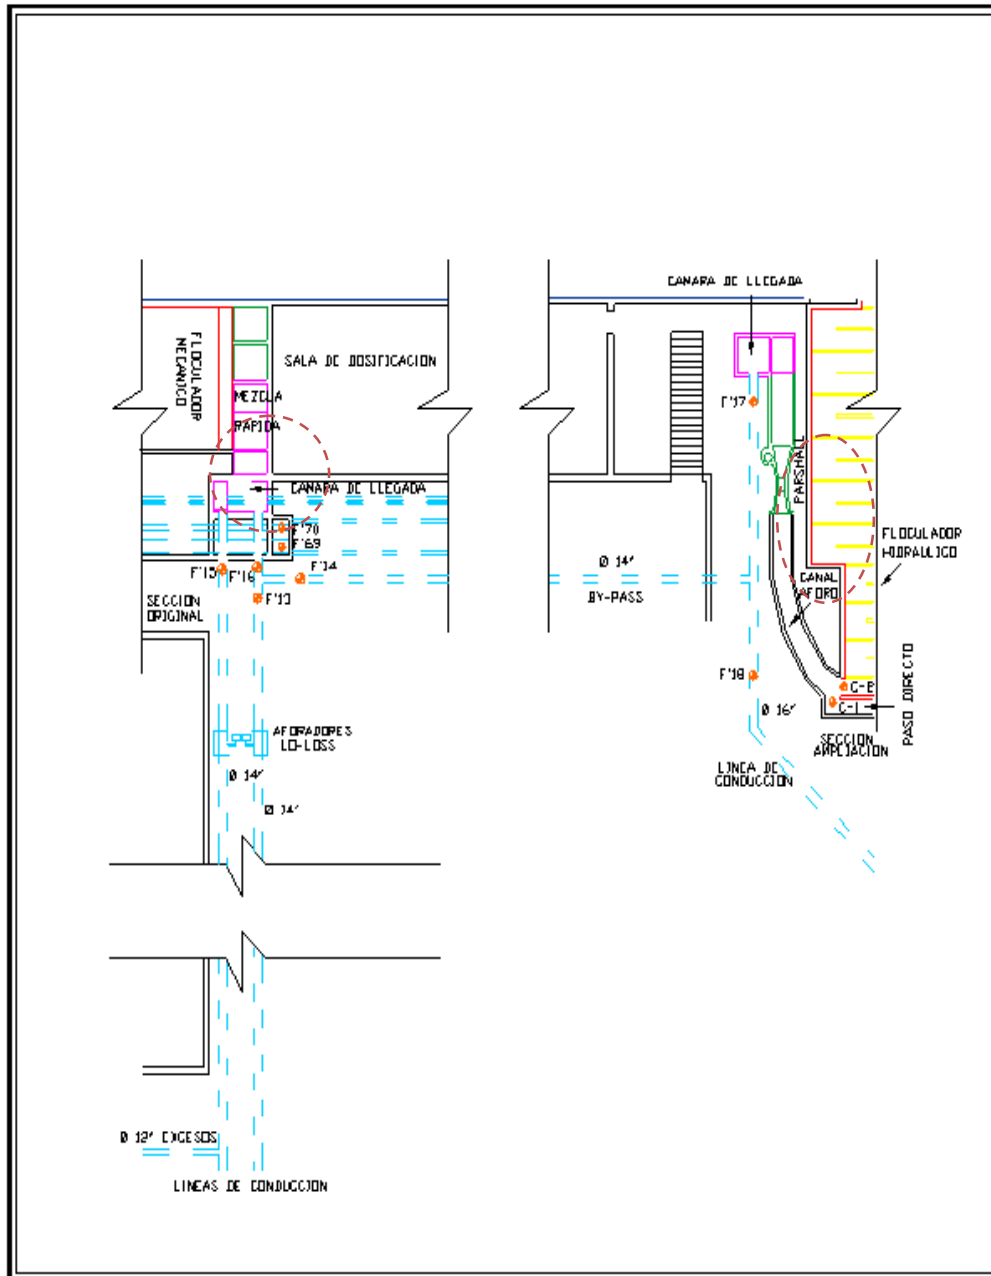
Secciones de la Planta de tratamiento de Floridablanca.
